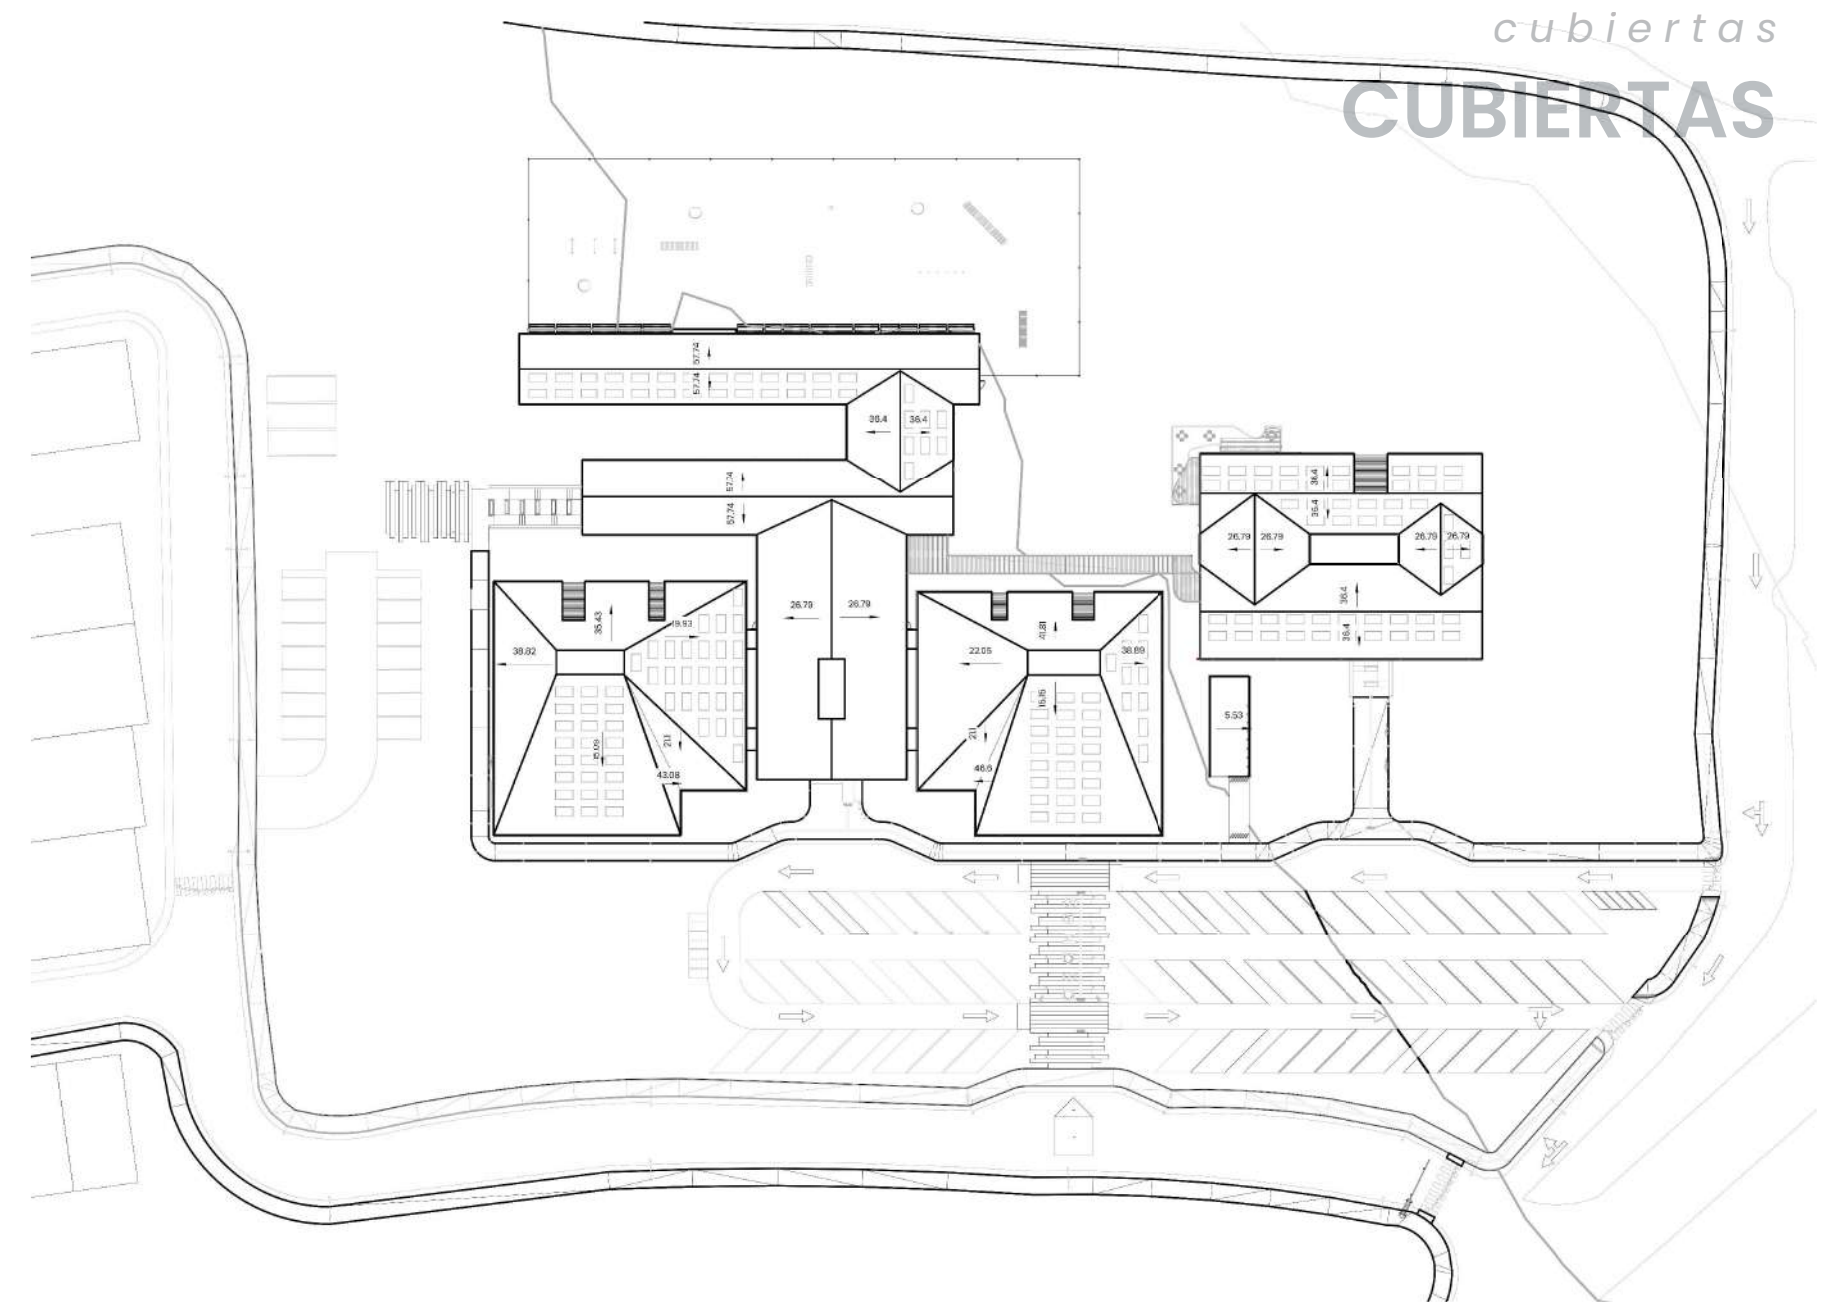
Planta de cubiertas. Fuente: Elaboración propia
